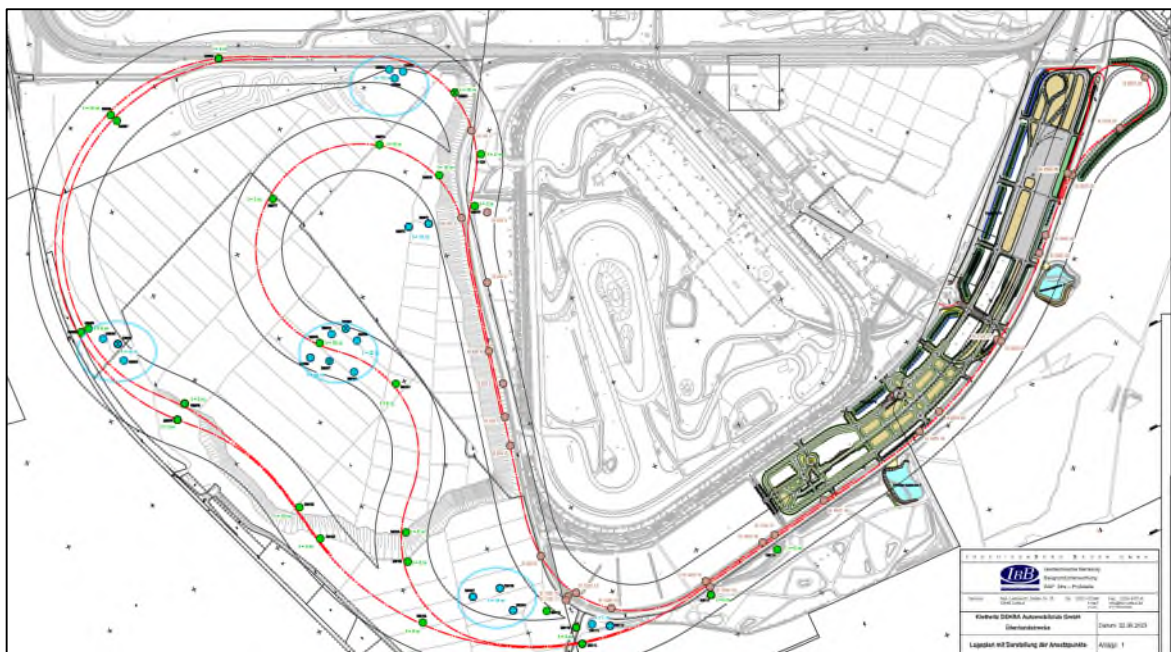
Bohrungen der Baugrunduntersuchung 2023 (hellgrüne Punkte), vorhandene Bohrungen aus dem Jahr 2021 (braune Punkte) und Lage der Versickerungsversuche 2023 (hellblaue Punkte) entlang der Überlandstrecken /13/ /1/
